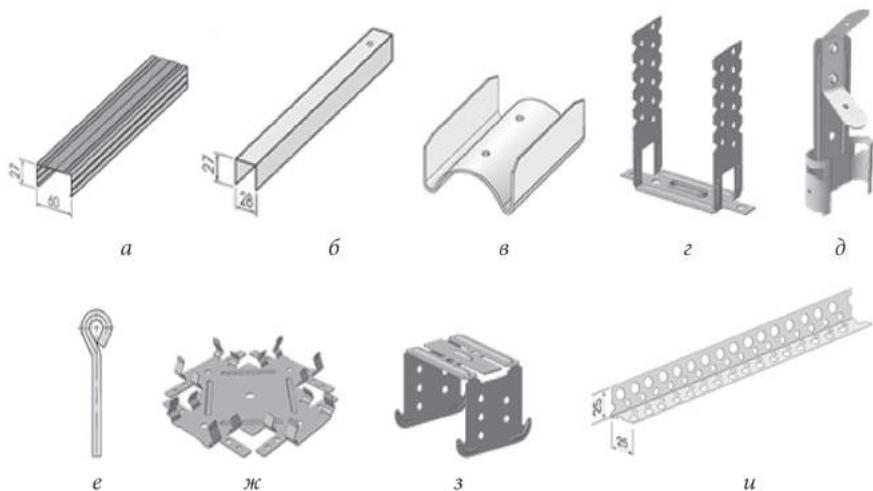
Элементы каркаса подвесных потолков: а — потолочный профиль ПП 60×27; б — профиль направляющий ПН 27×28; в — удлинитель профилей; г — подвес прямой; д — подвес анкерный; е — стержень (тяга); ж — одноуровневый соединитель; з — двухуровневый соединитель; и — перфорированный угловой профиль
